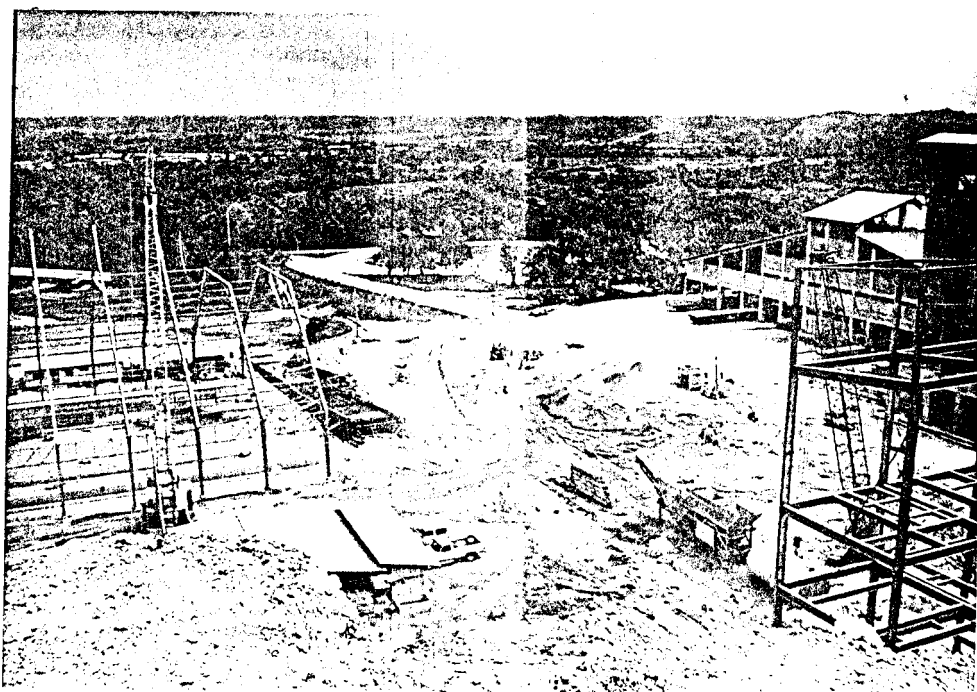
VIAS PAVIMENTADAS Y CARRILES DE ENVASE
